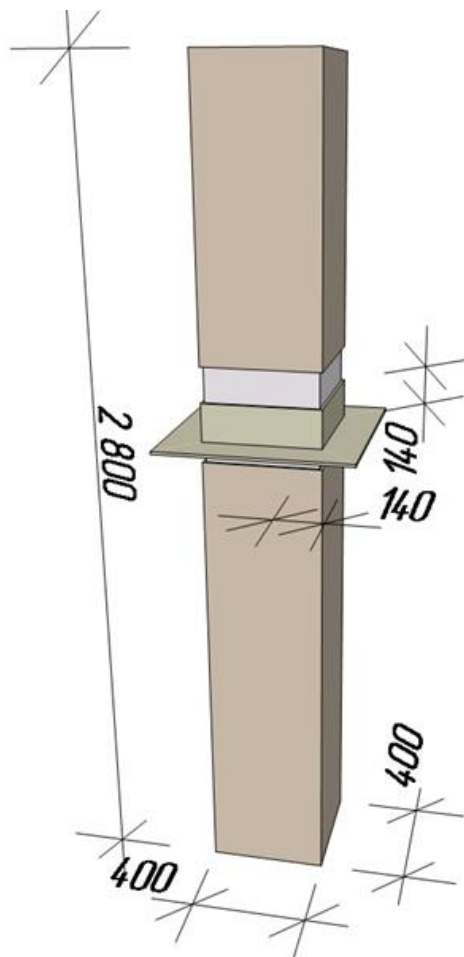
Схема залізобетонної колони, що підтримує безбалкове перекриття
